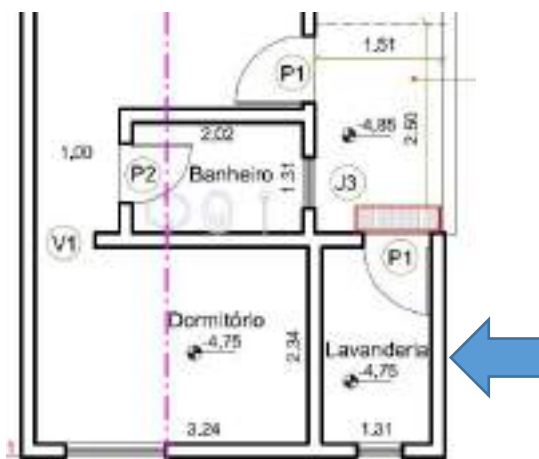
Localização da tubulação de água pluvial existente (embaixo do piso da lavanderia) a ser desentupida.
